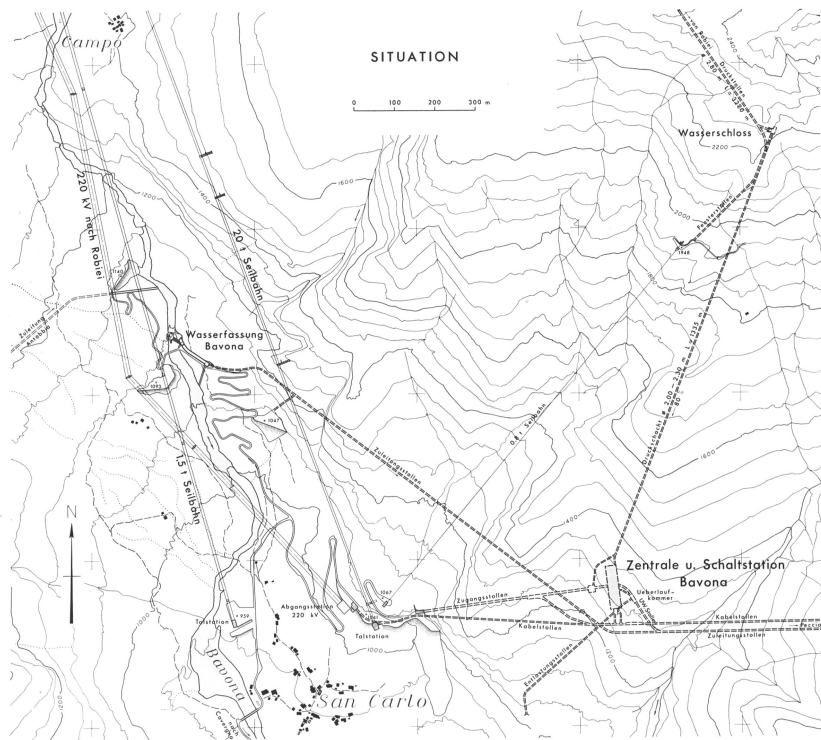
Kraftwerk Bavona, Lageplan 1 : 10 000
